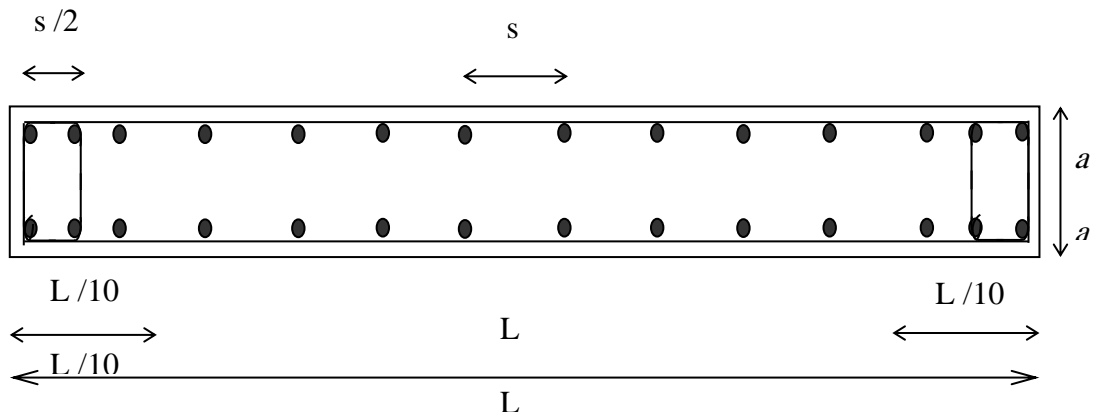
disposition des armatures verticales et horizontales dans les voiles.
